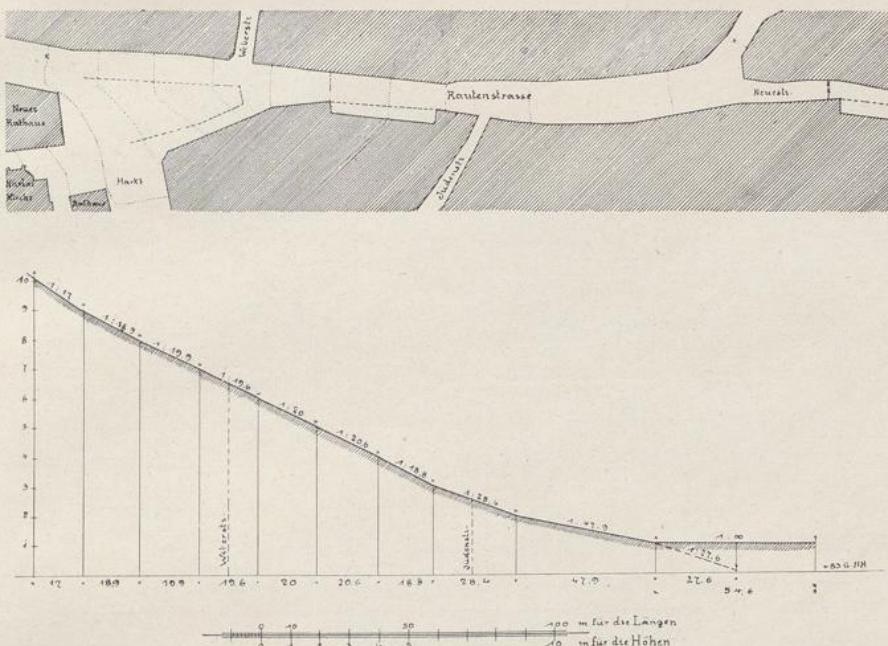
Konkaves Längsprofil (Nordhausen, Rautenstraße).
